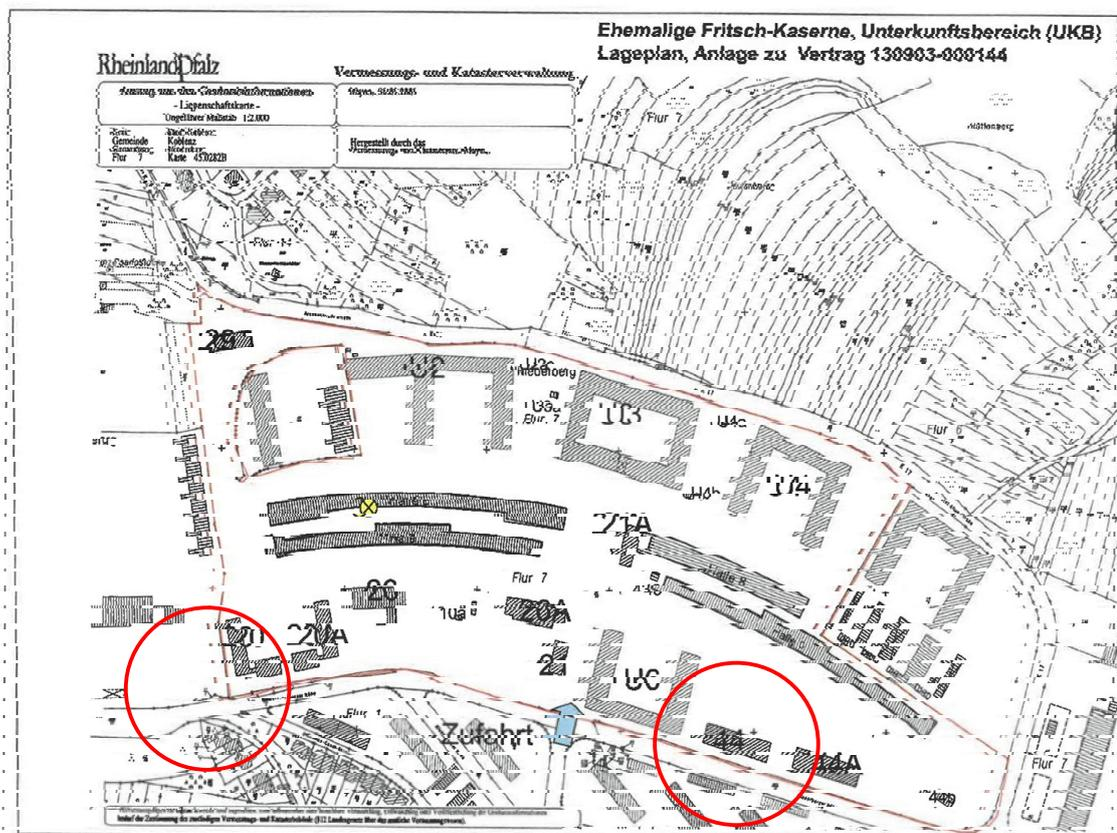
Lageplan Bestandssituation inkl. Markierung der geplanten Anbindungen, Darstellung BPD
